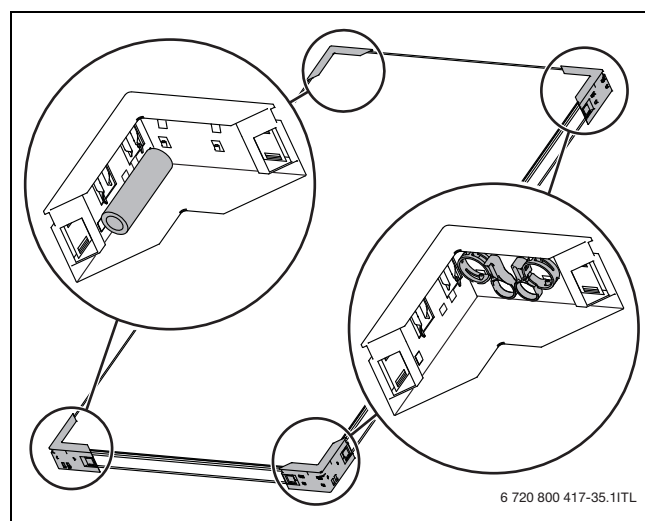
1 kit de raccordement toit terrasse et 2 kits de connexion
